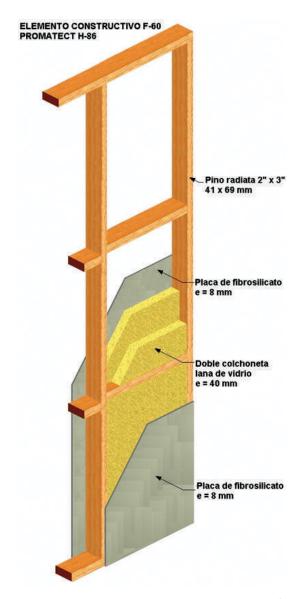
33: Elemento constructivo F-60 Promatect H-86.
